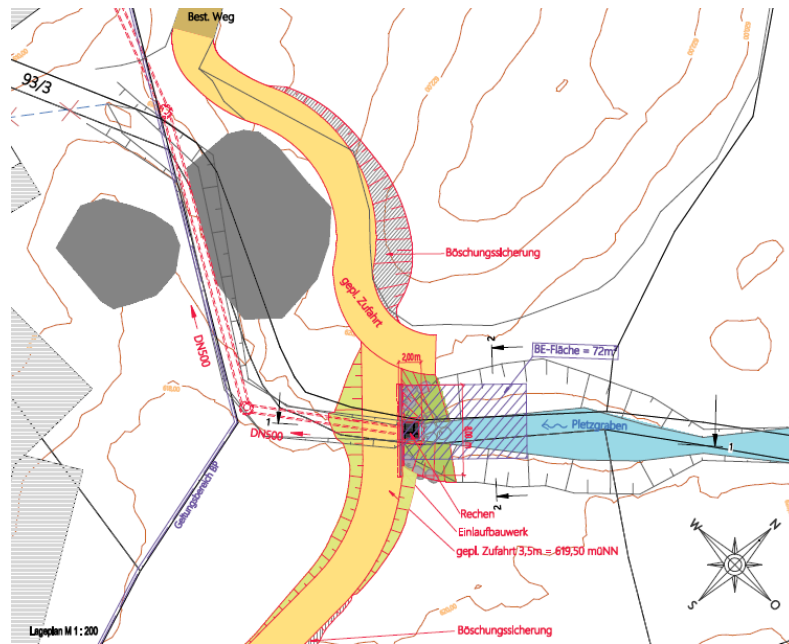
Planauszug E-DP-6.2 – Lageplan Einlaufbauwerk Pletzgrabenverrohrung.
